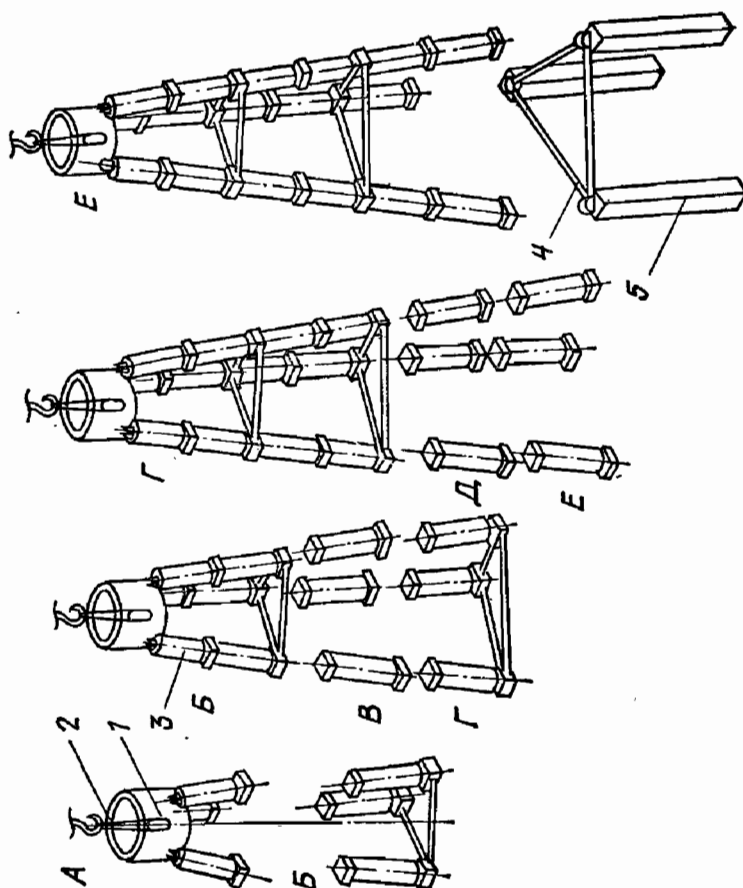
Укрупнительная сборка и установка опорной треноги:
